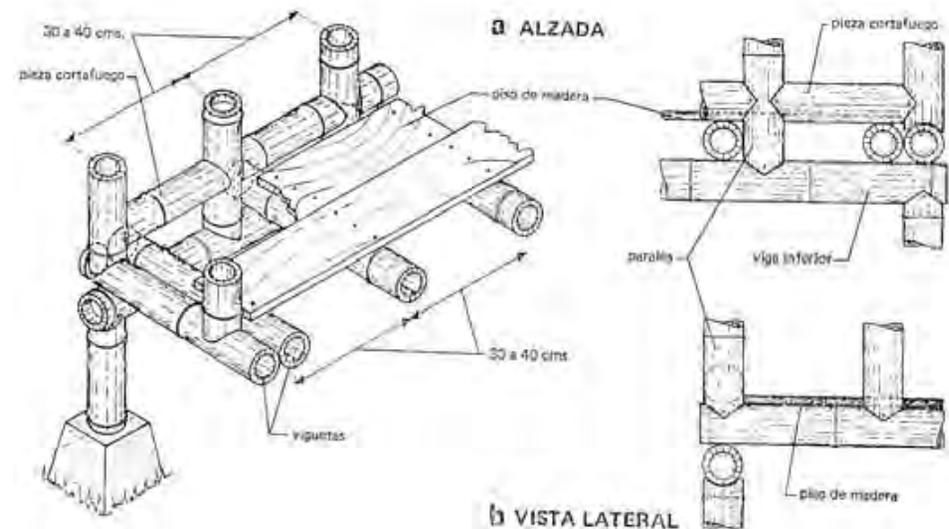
, Construcción del piso y el entramado de las paredes con secciones de bambú, Hidalgo 2006
